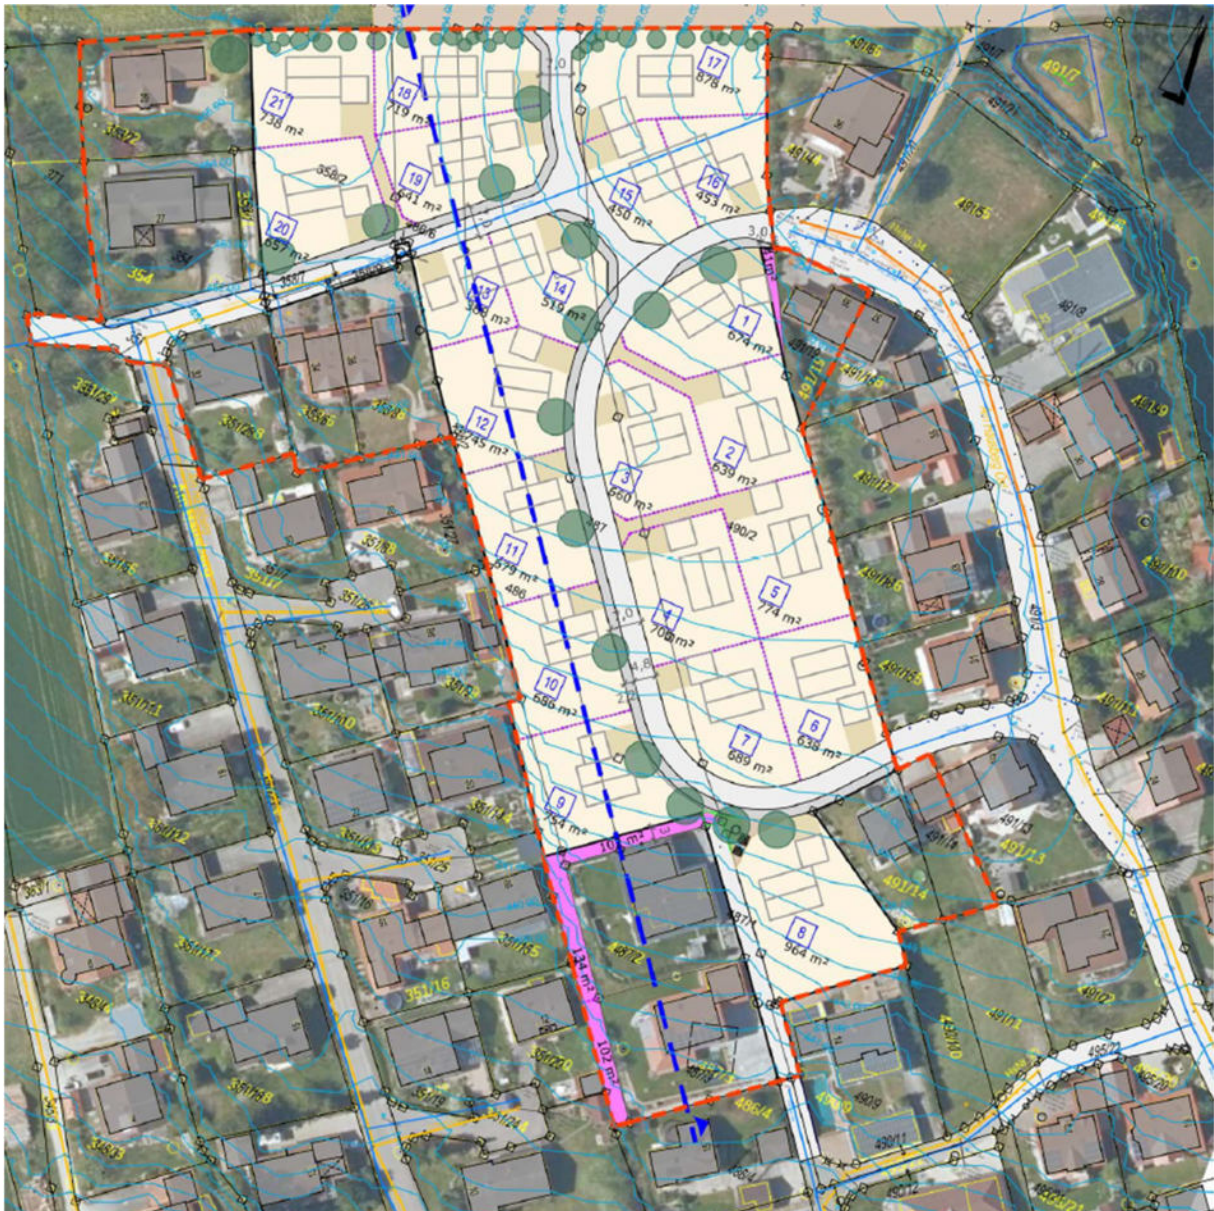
Auszug aus dem städtebaulichen Konzept vom 26.05.2021 – Lageplan (ohne Maßstab); Planung Jocham + Kellhuber (Mai 2021)
